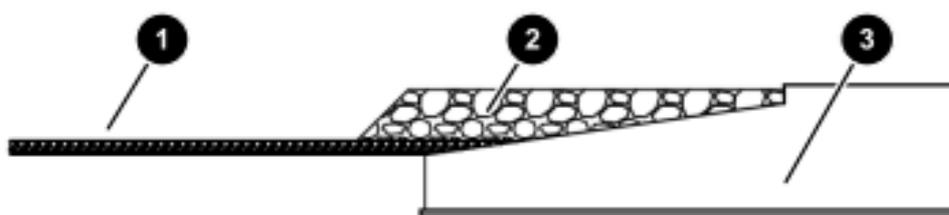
Fundament Teilanschüttung mit Erdauflast
